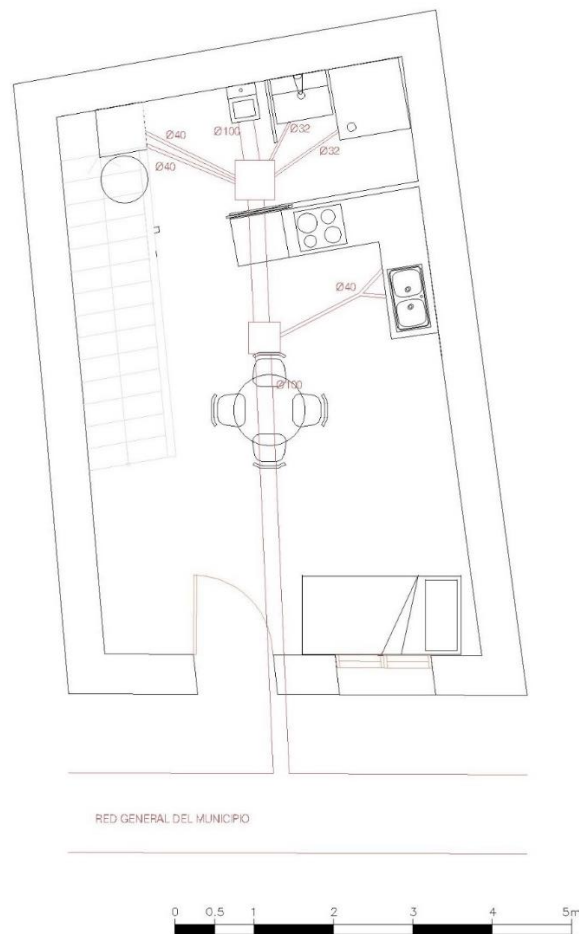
Instalación de saneamiento de la vivienda tipo. Fuente: Propia
